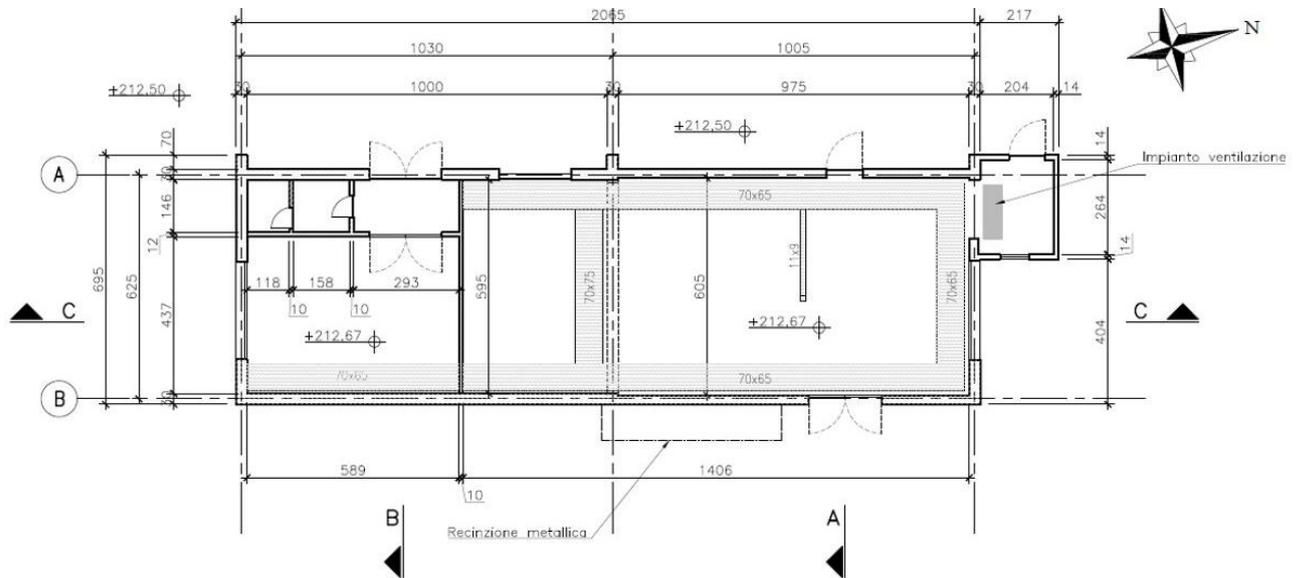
Pianta dell'edificio 21h - Ante Operam
